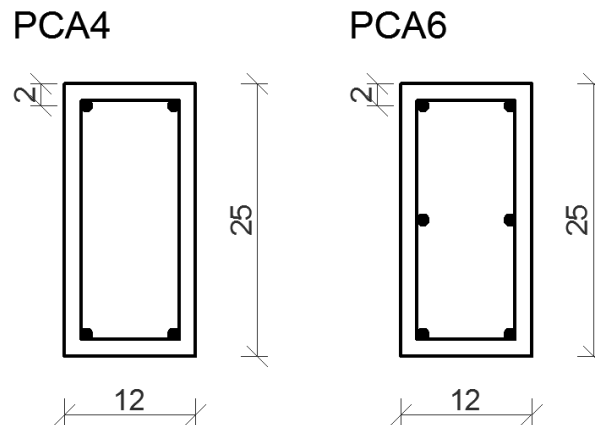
Disposição das armaduras para os pilares de Araújo (2004).
